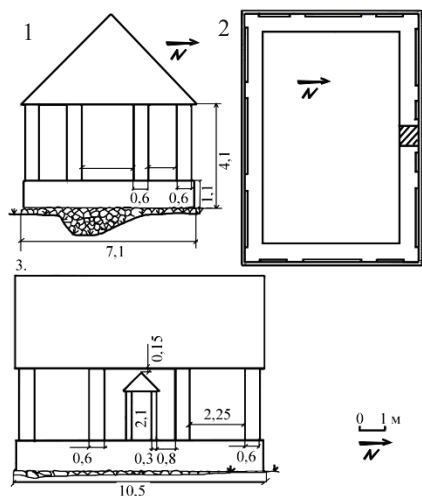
План и наиболее сохранившиеся фасады флигеля (?) с обмерами:
